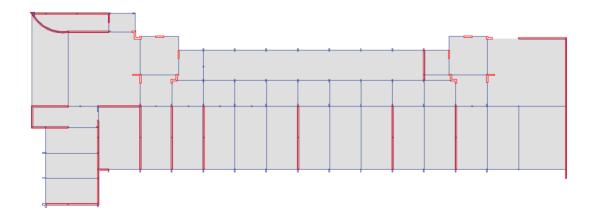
Planta segundo piso, Escuela Unión Latinoamericana Edificio 1.
